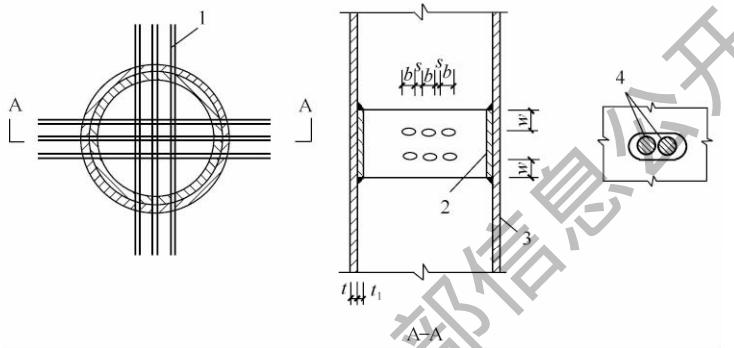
钢筋直接穿入梁柱节点构造示意图
